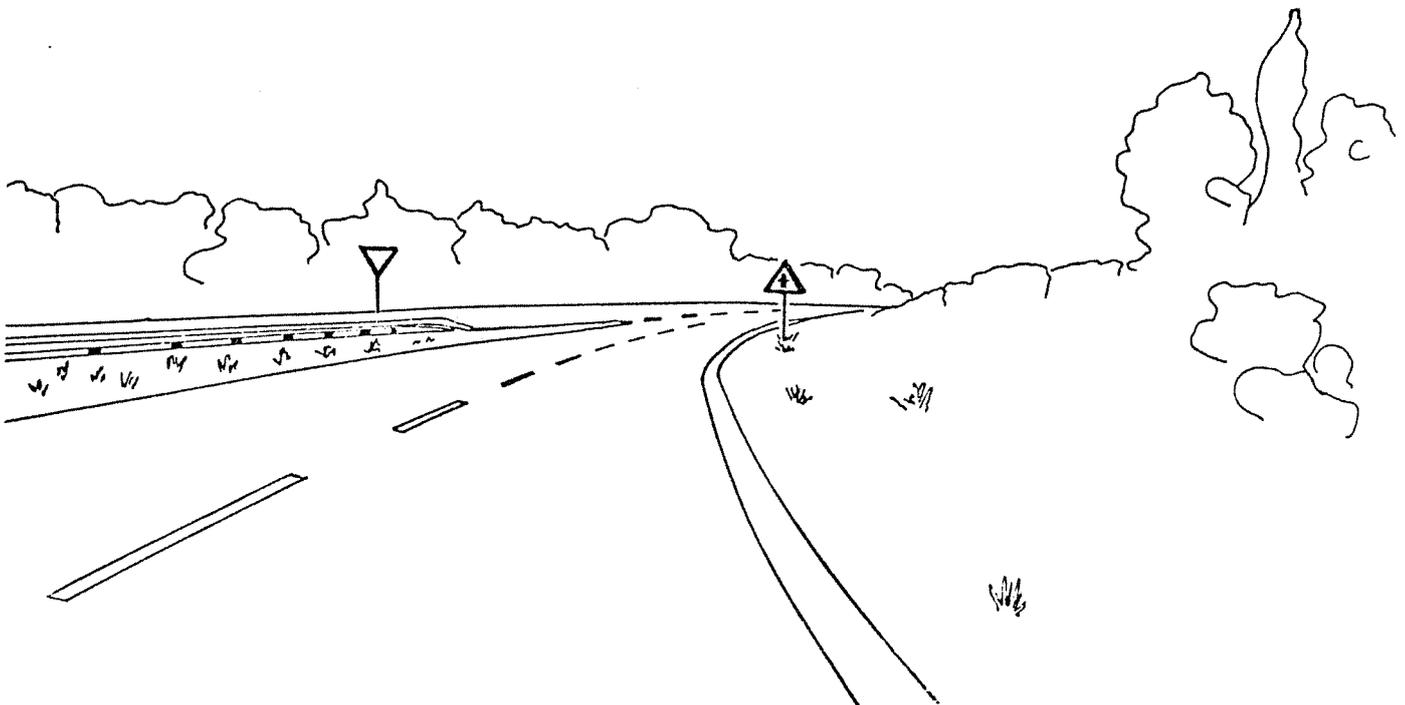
Beschilderung an der Mündung zweier Ausfahrtrampen
